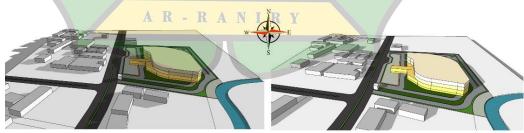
Sirkulasi Ruang untuk Merespon Angin Angin ke dalam Bangunan Sumber: Pinterest
